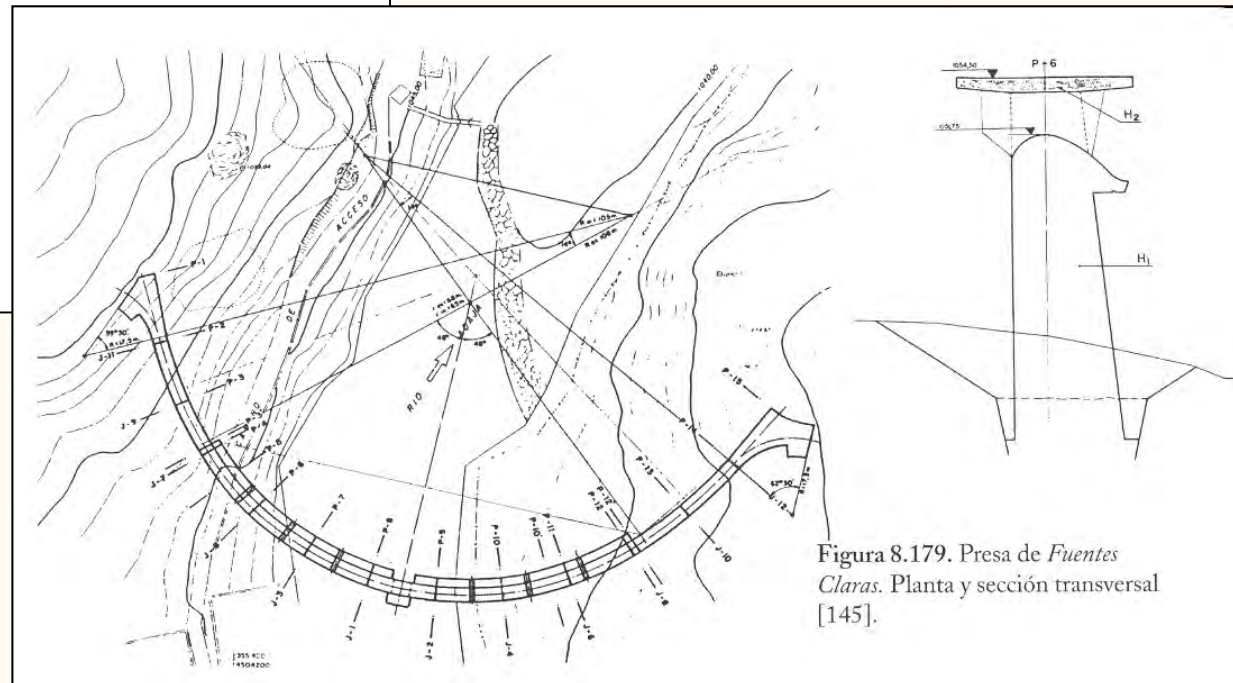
Presa de *Fuentes Claras*. Planta y sección transversal [145].
